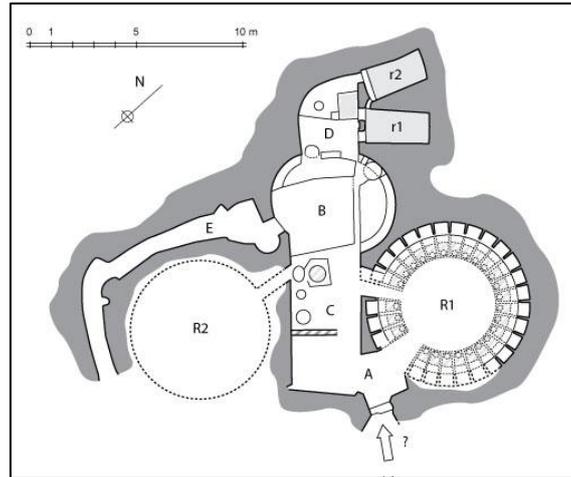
Plan des bains du Pirée. Source BOUSSAC¹⁸⁶
